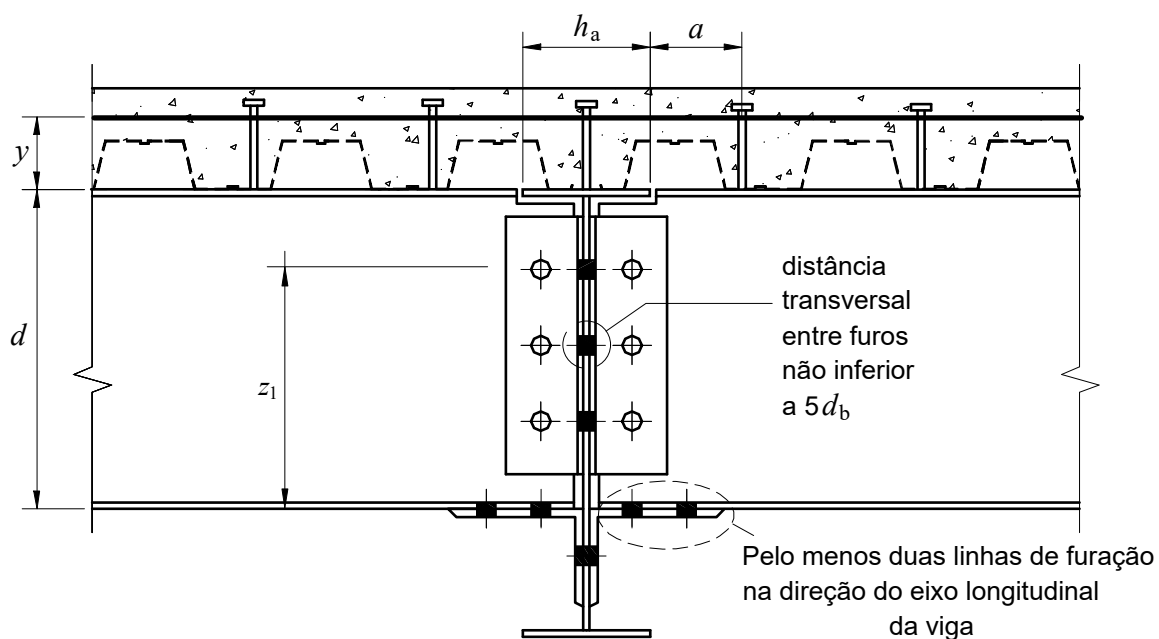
Ligação mista com cantoneiras parafusadas na alma (duas por viga) e na mesa inferior da viga apoiada
